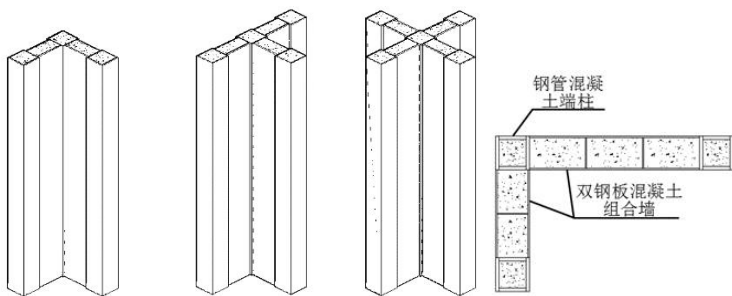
双板连接型矩形钢管混凝土组合异形柱
